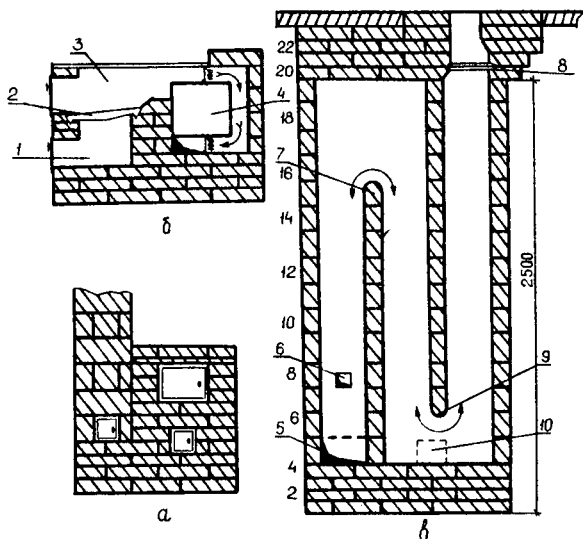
Отопительно-варочная печь № 7: а — вид спереди; б — устройство топливника; в — система дымоходов; 1 — зольник; 2 — колосниковая решетка; 3 — топливник; 4 — духовка; 5 — канал из-под духовки; 6 — подсосный канал; 7 — перевал; 8 — задвижка; 9 — подверток; 10 — окно чистки
